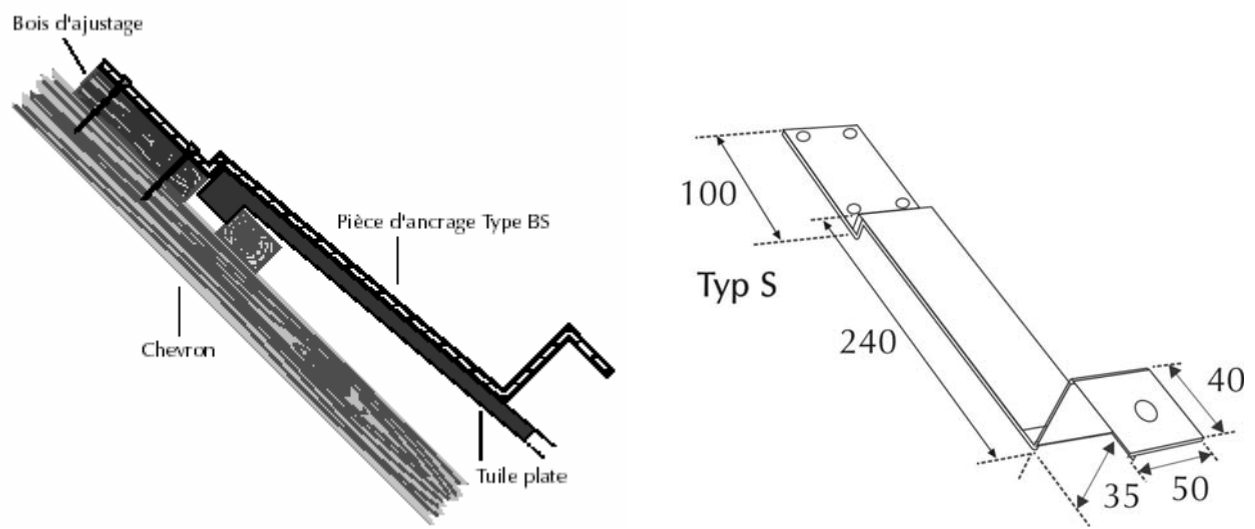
Patte de fixation de type S pour toiture inclinée, tuiles plates ou ardoises
